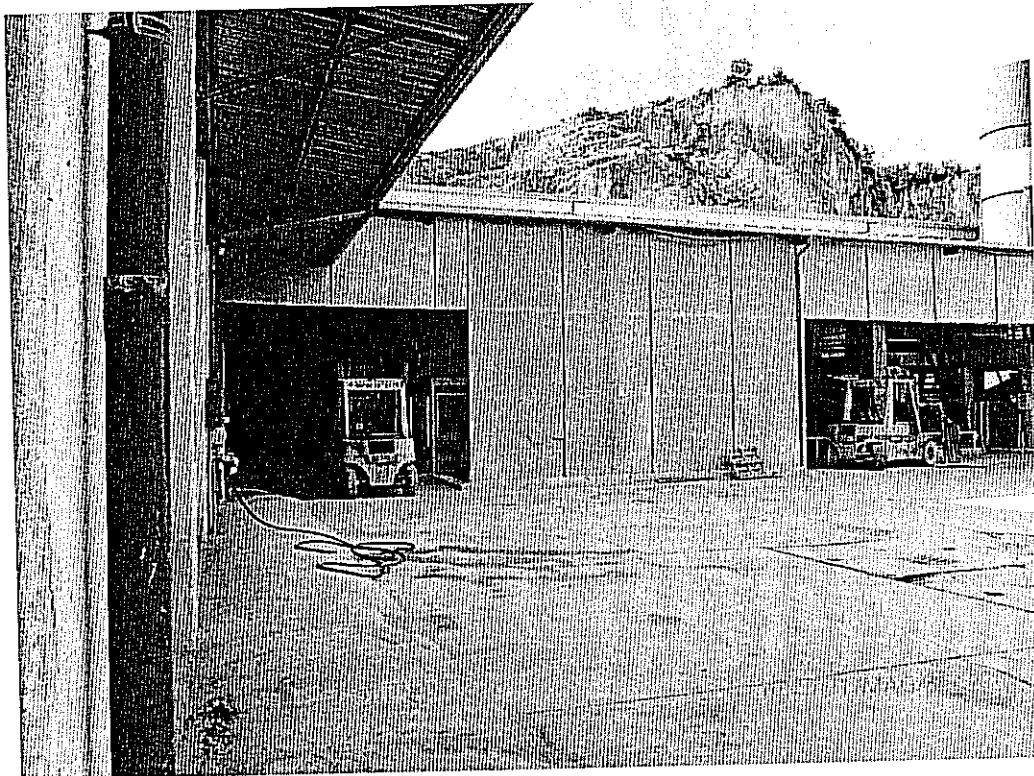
Corpo aggiuntivo al capannone manufatti in c/c
